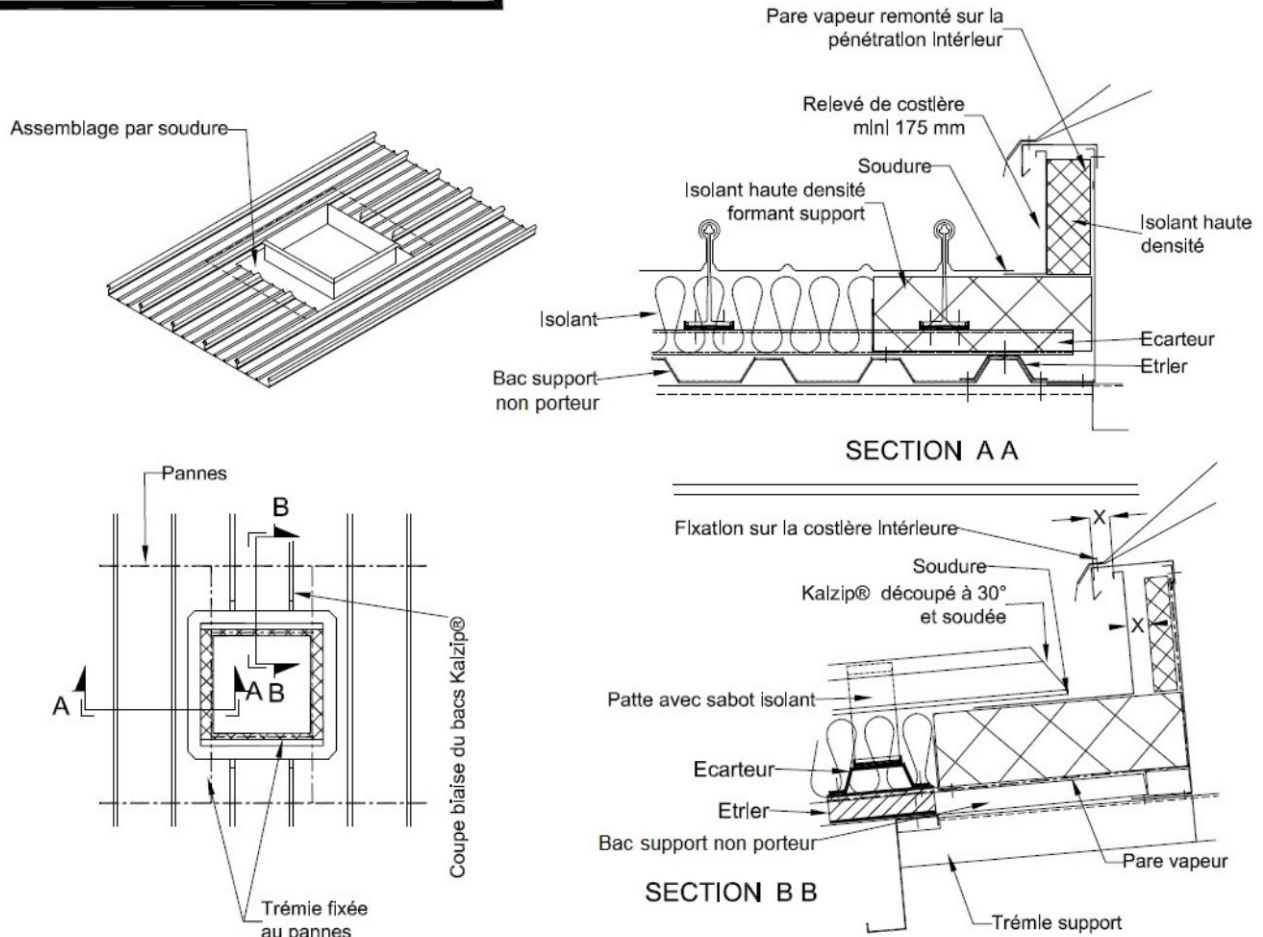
Pénétration raccordée au Kalzip® par soudure
